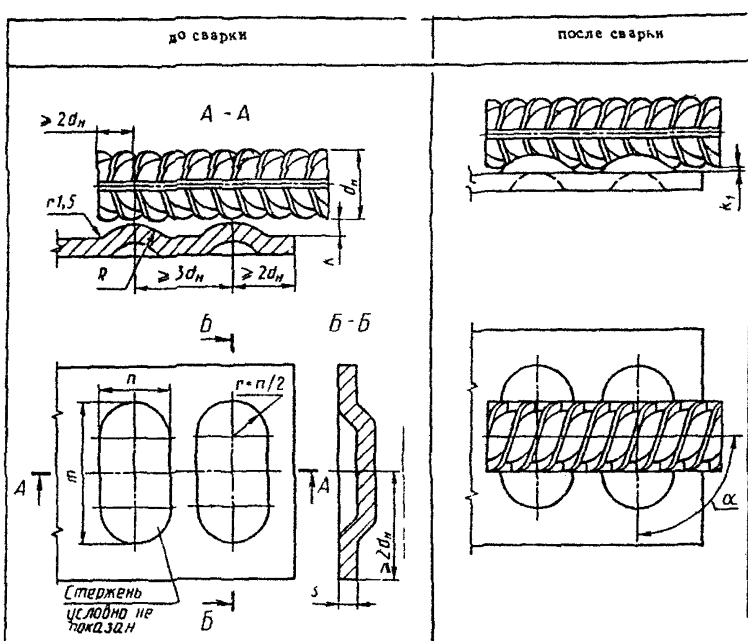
Конструкция нахлесточного соединения, выполняемого контактной точечной сваркой по двум рельефам на пластине
